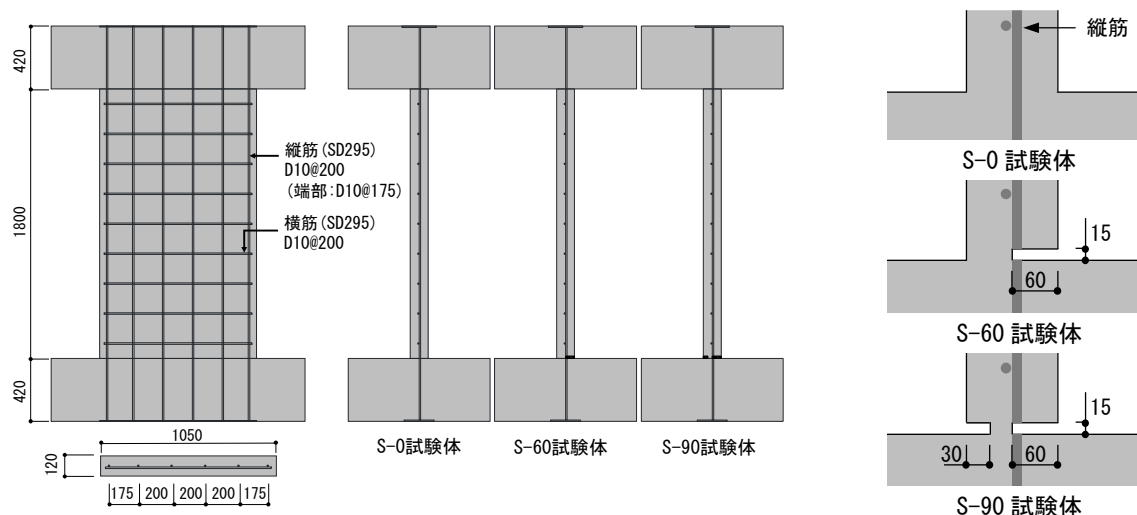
試験体の配筋図及びスリット部分詳細図 (unit:mm)
